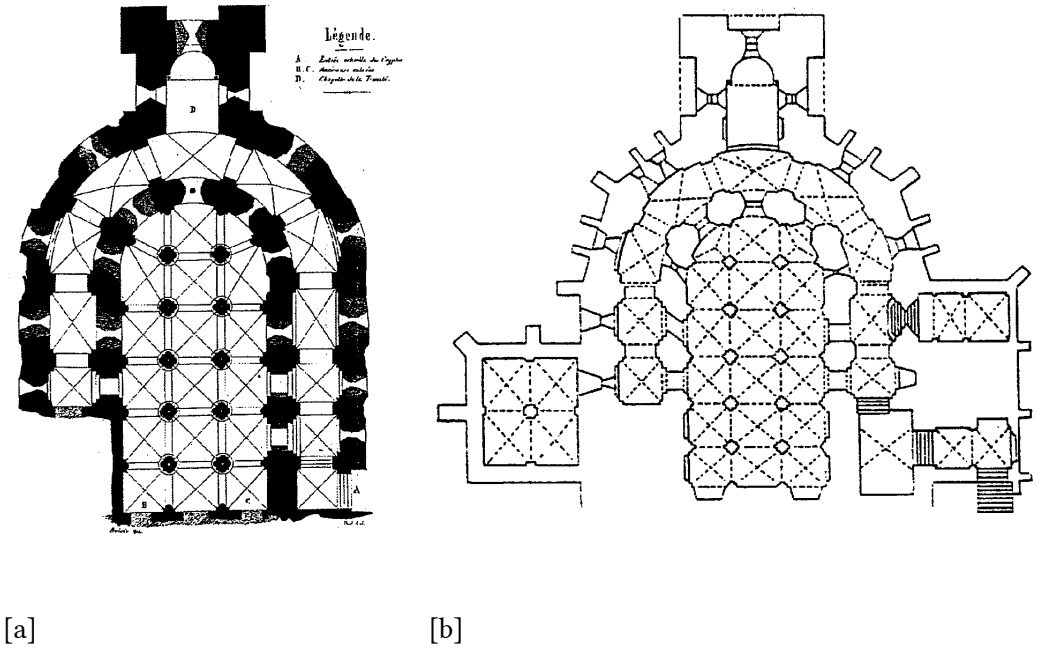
Grundriss der Krypta nach Boivin [a] und nach Th. King [b]
